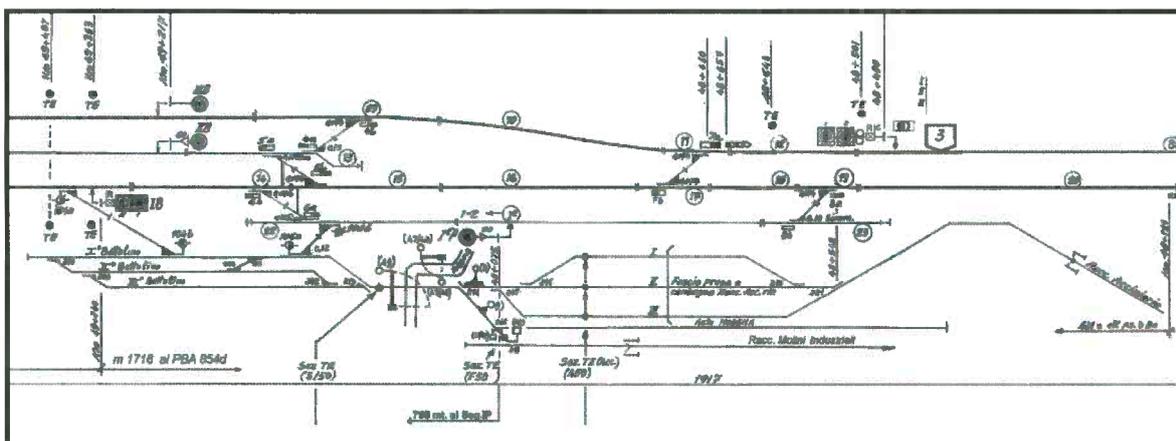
Estratto del piano schematico della stazione di Rubiera
